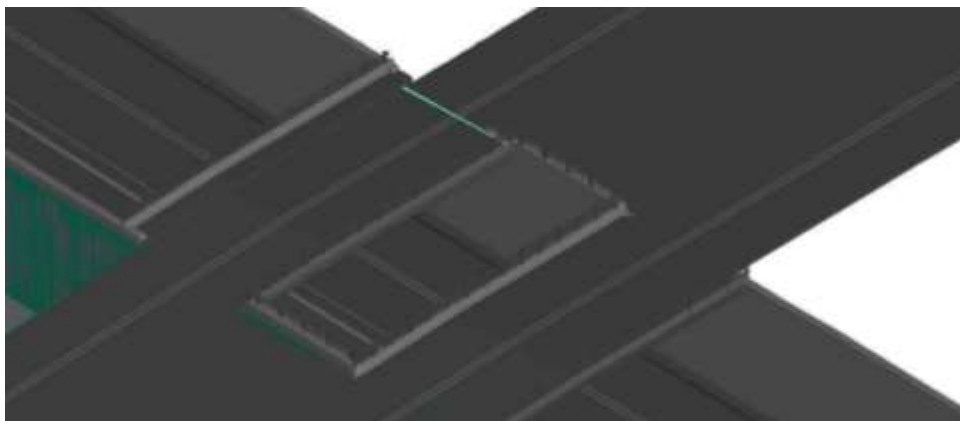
VISTA PROYECTADA-FUENTE: ELABORACION PROPIA
